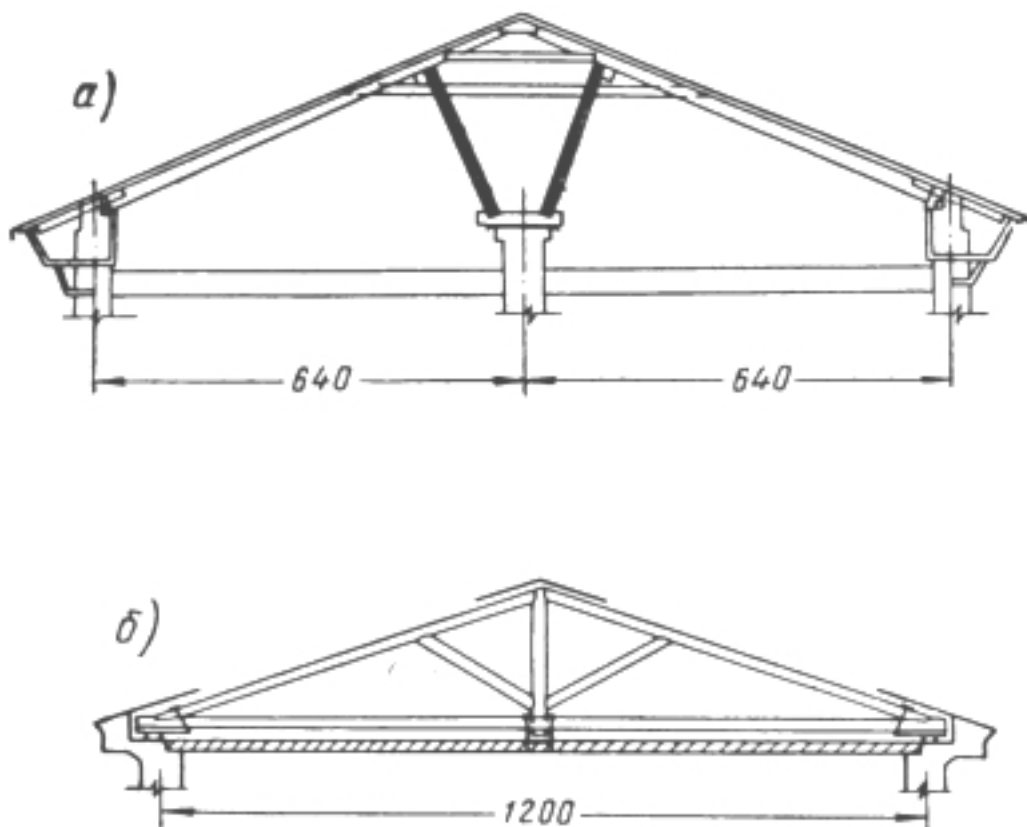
Стропила деревянные. а — наклонные; б — висячие
